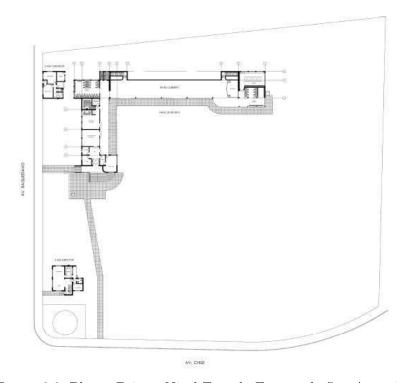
Planta Primer Nivel Escuela España de San Antonio.[2]
